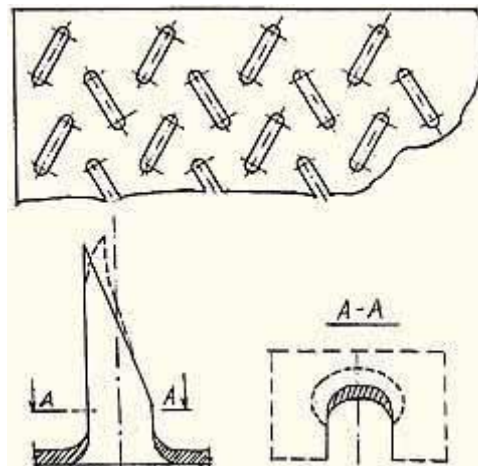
Металлическая зубчатая пластина типа «Arpad»
